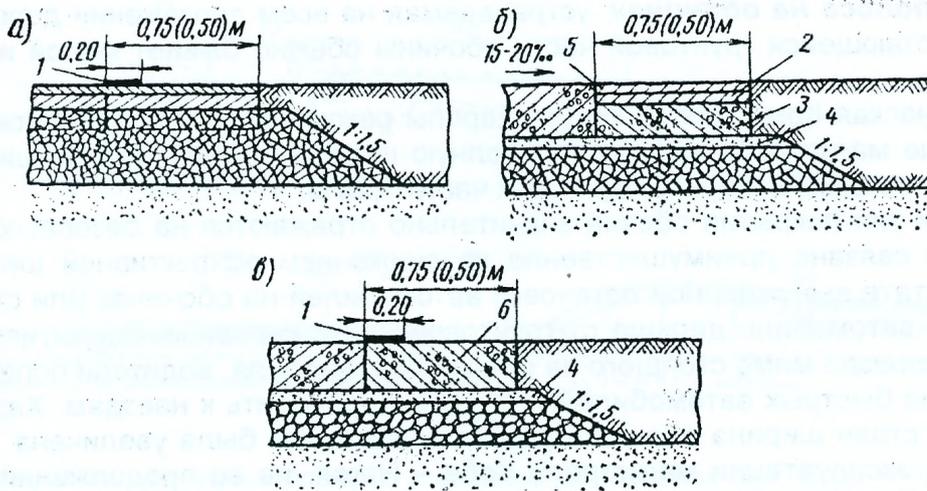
Конструкция краевых полос: а – устраиваемых путем уширения проезжей части; б – из сборных бетонных плит; в – бетонированные на месте; 1 – наносимая краской разметочная линия; 2 – предварительно изготовленная на заводе плита из белого бетона толщиной 6 см; 3 – монолитный бетон; 4 – выравнивающий слой из песка или песка, обработанного органическими вяжущими материалами; 5 – заполнение шва битумной мастикой; 6 – плита, забетонированная на месте
